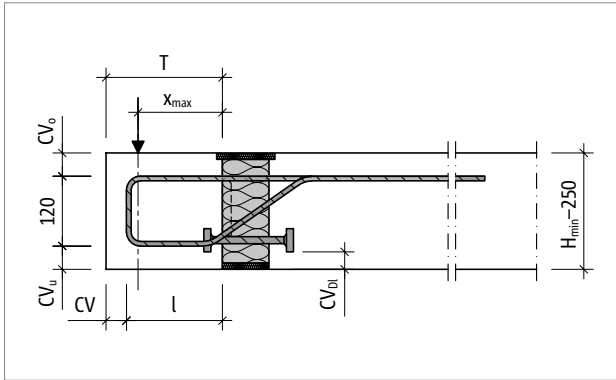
Schöck Isokorb® T Typ OP: Produktschnitt
